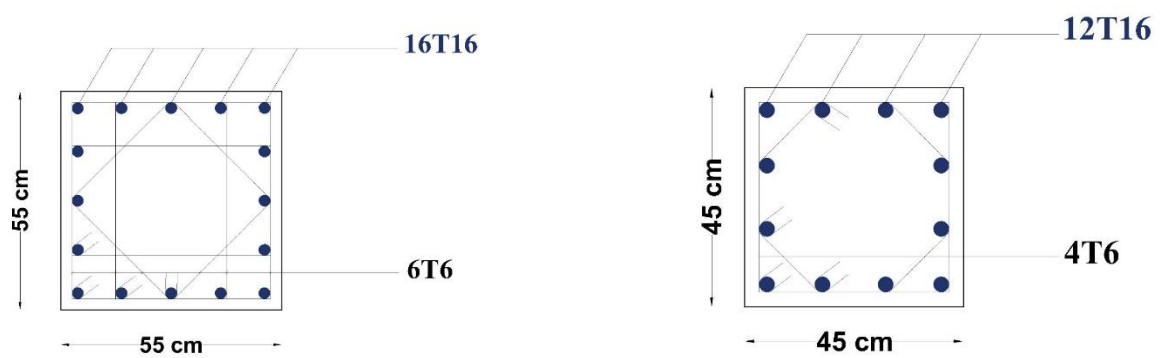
Schéma de ferrailage des poteaux (55x55) et (45x45)
